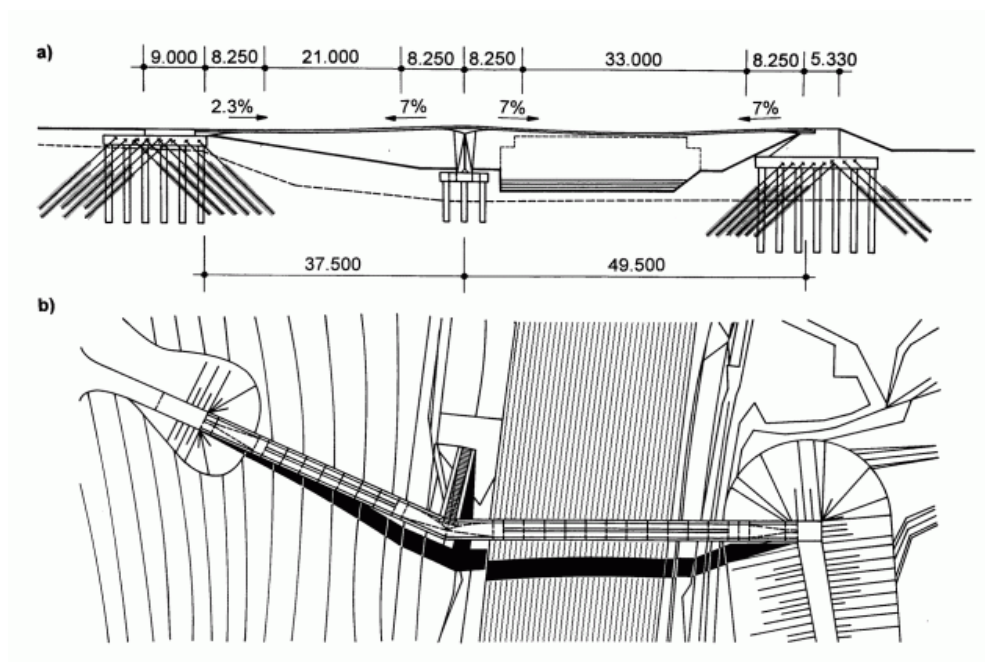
Maidstone Bridge*: (a) Alçado; (b) Vista [7]
